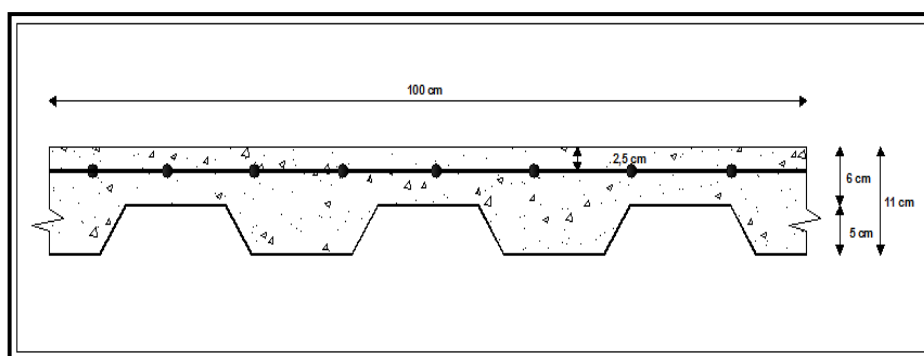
Corte de losa sobre Deck metálico h= 11 cm
